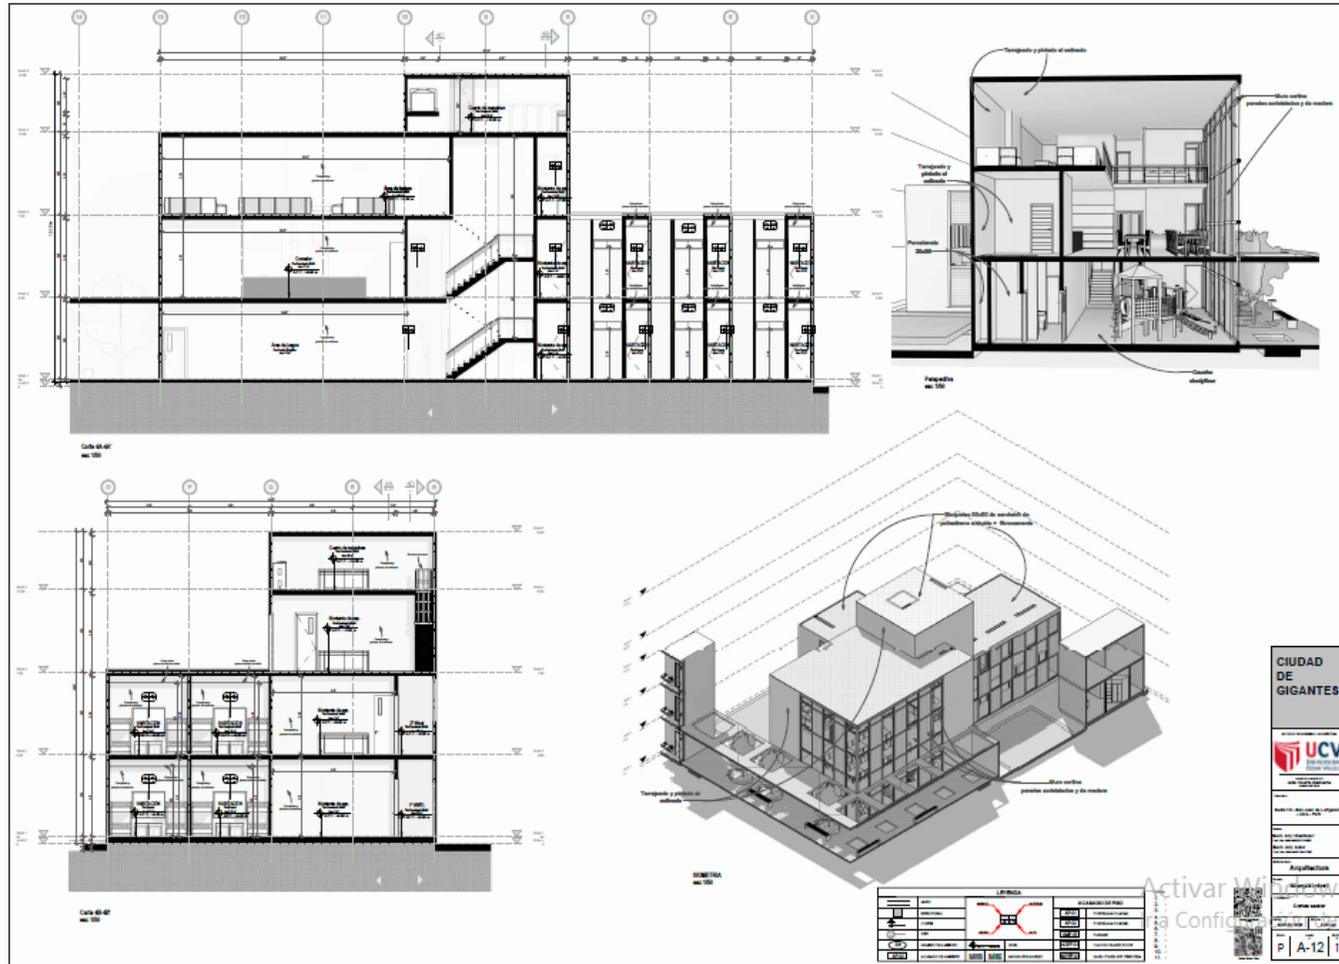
Plano de Cortes Sector Residencial (Sector Elegido)
